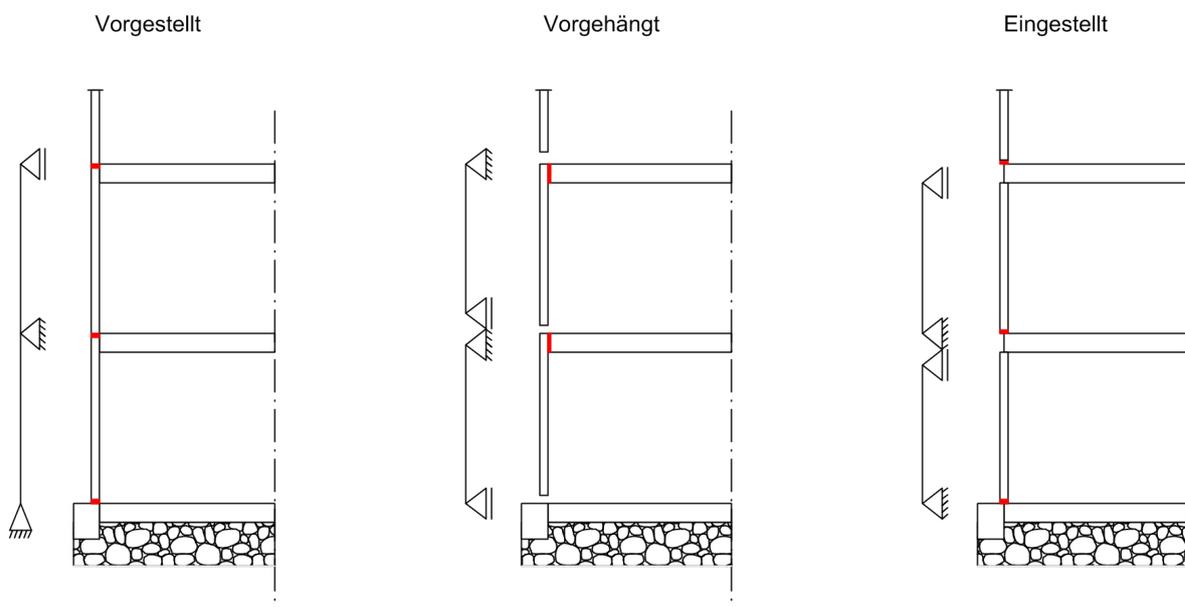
Anschlussvarianten nichttragender Fassadenelemente (Eigene Darstellung)
